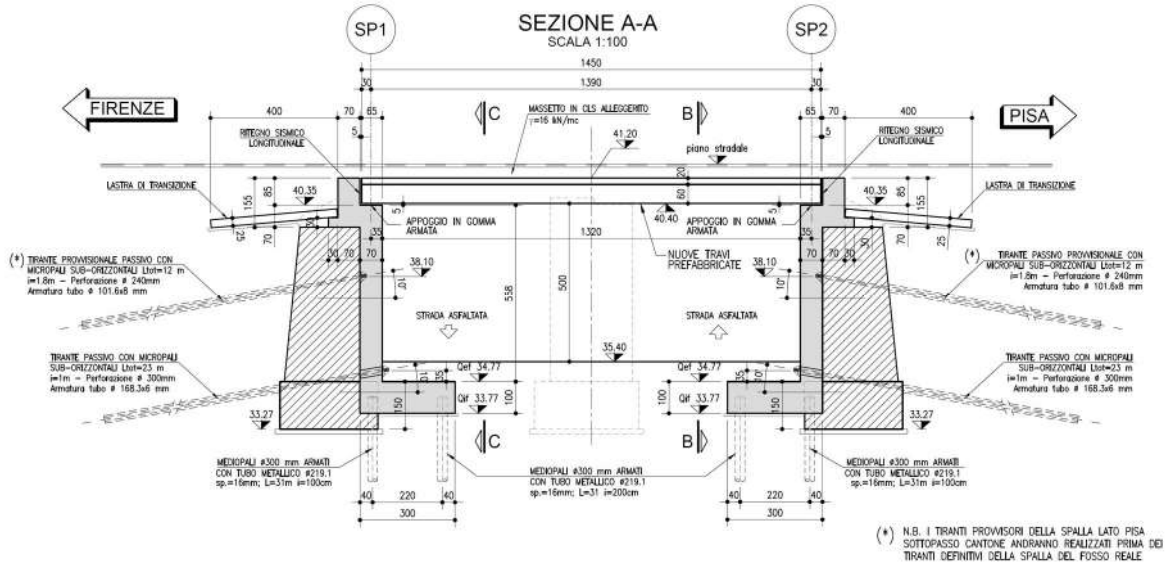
Sottovia Cantone. Sezione longitudinale sull'esistente
